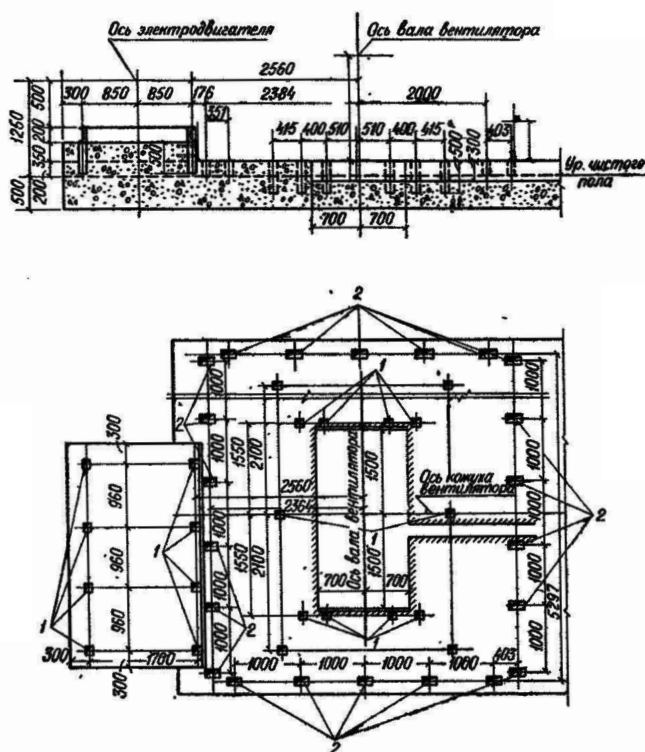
Фундамент под вентиляторный агрегат и камеру
